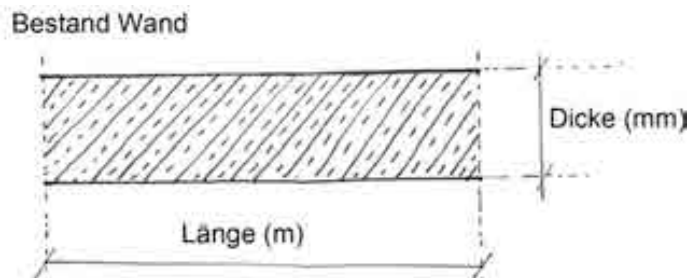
Bestand Wand, Bestand Stahlbeton
